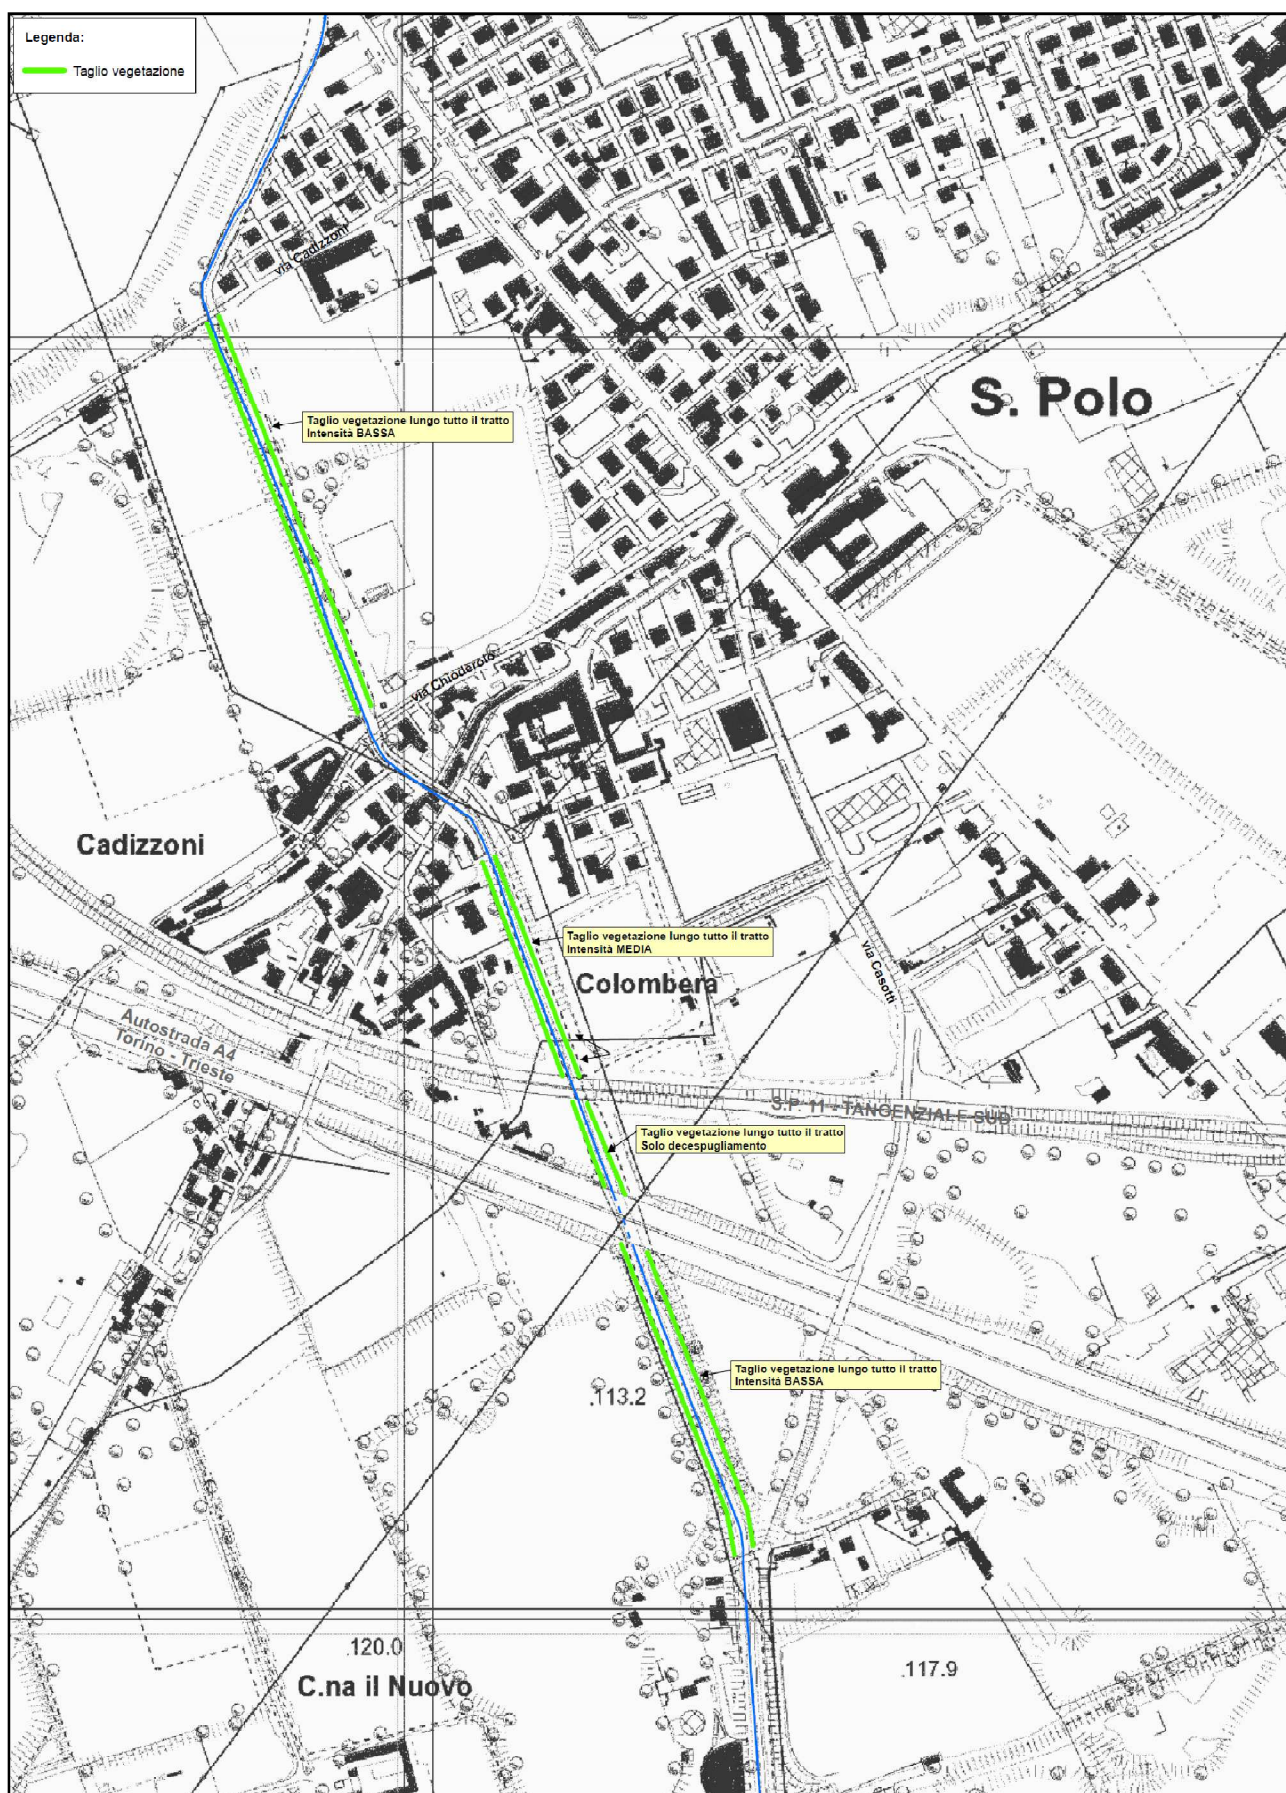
Planimetria di progetto T. Garza (sud) loc. San Polo
